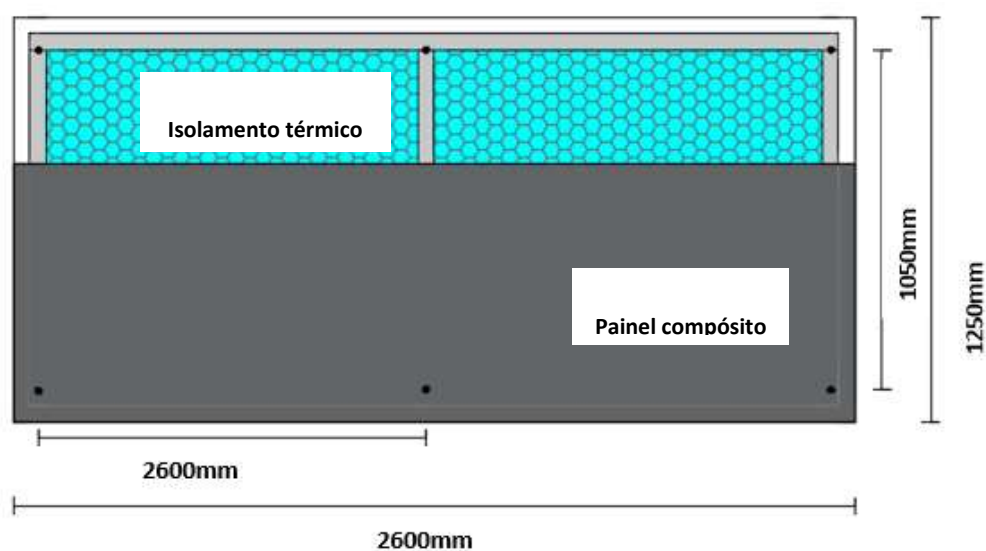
Pormenor construtivo n.º 5 no Centro de Saúde de Montalegre.
